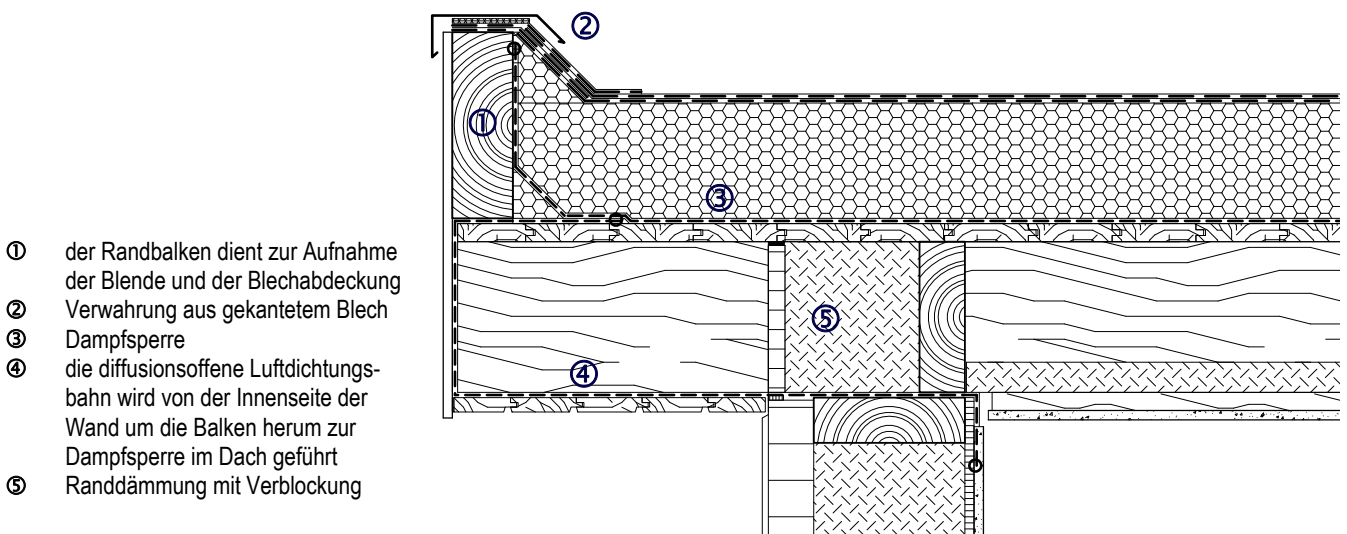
Für ein Flachdach mit aufliegender Dämmung (Typ I) wird hier der Dachüberstand mit ausragender Balkenlage dargestellt. Die Dachkante wirkt durch die große Höhe sehr massiv.
